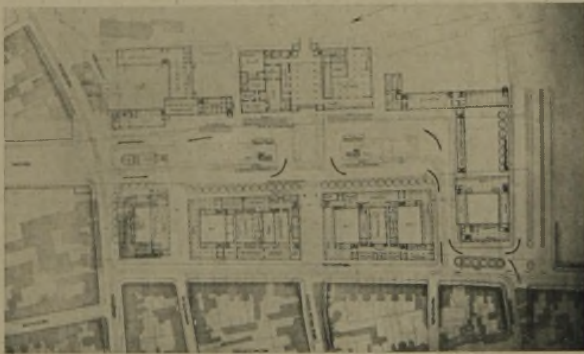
Lageplan zum Entwurf „Divide et impera“,
